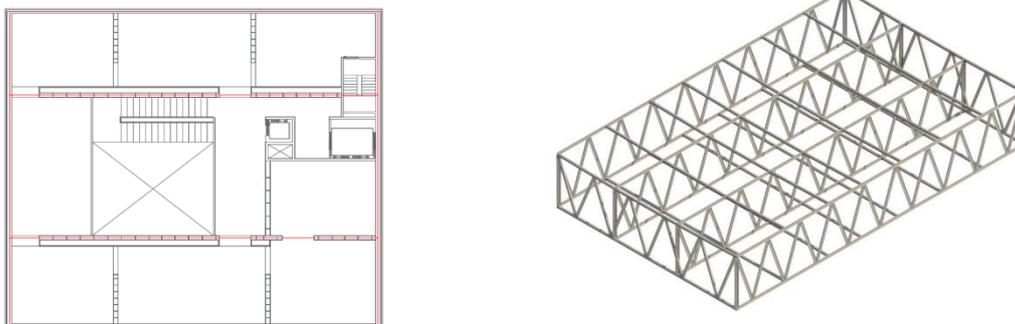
Planta e axonometria da estrutura do Piso 2
